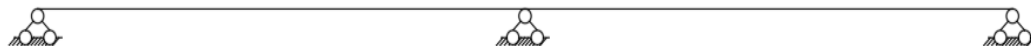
Расчетная схема плиты перекрытия.
